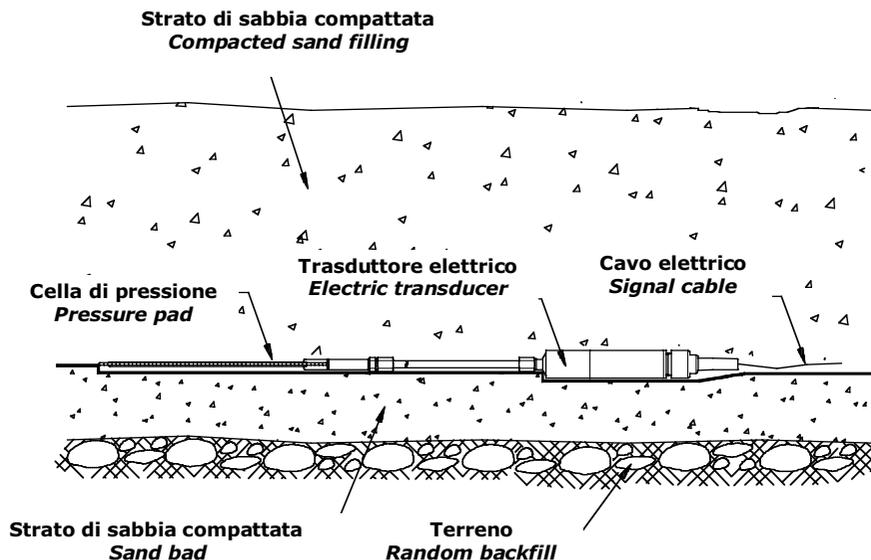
Installazione orizzontale in terreni e rilevati
